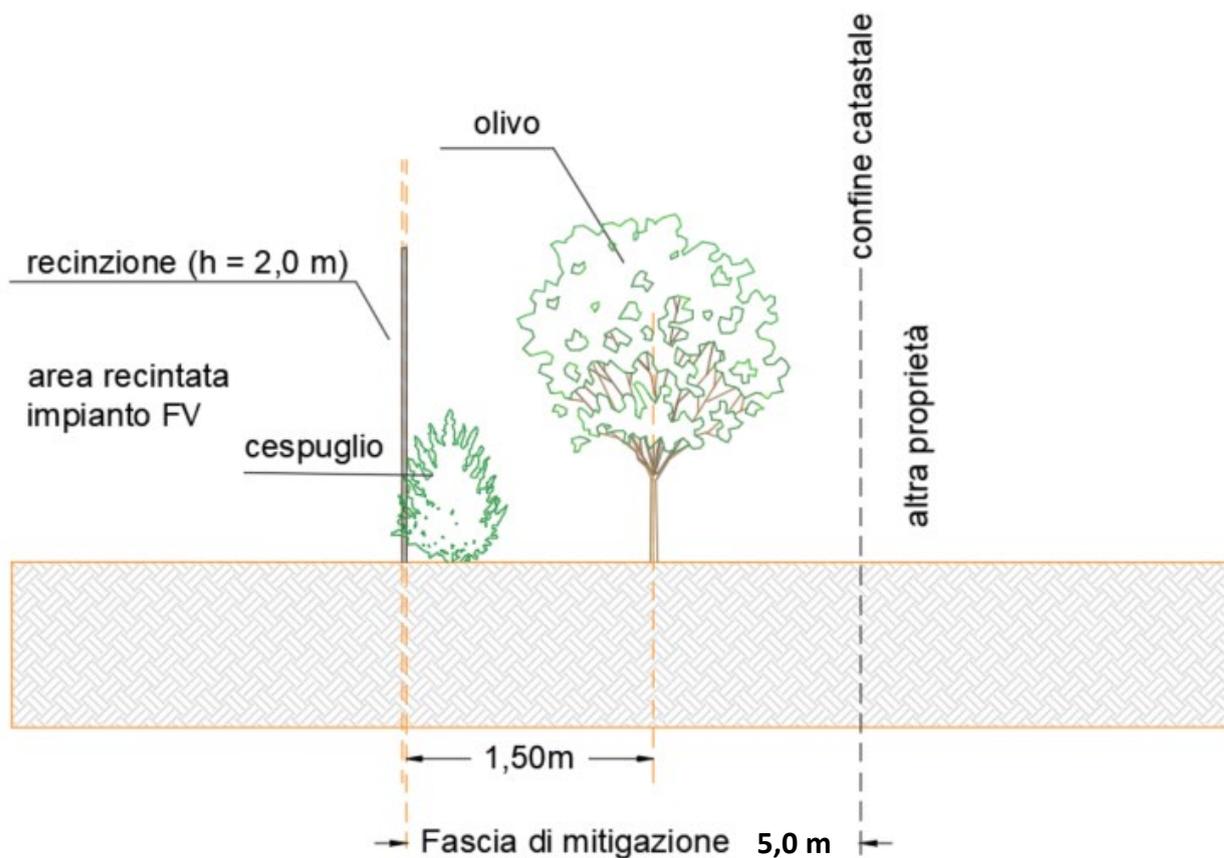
Stralcio di sezione dell'area perimetrale dell'impianto.
